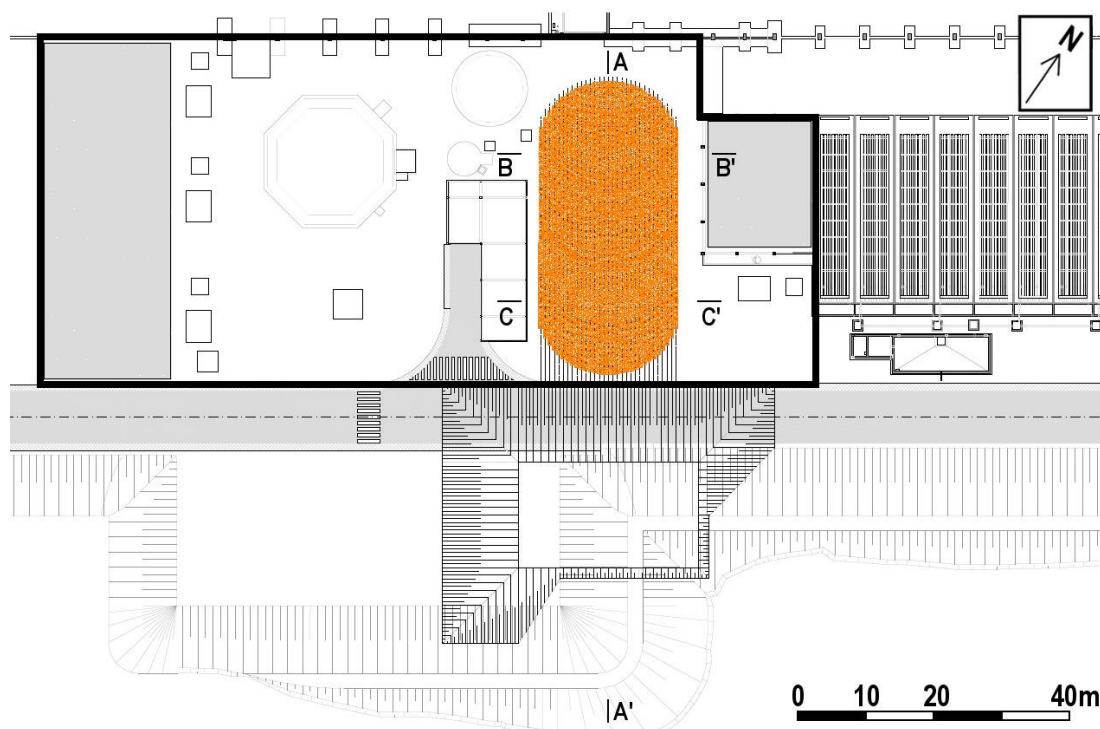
Planta com a localização dos elementos de *jet grout* sub-horizontais (Edifer, 2011g)
